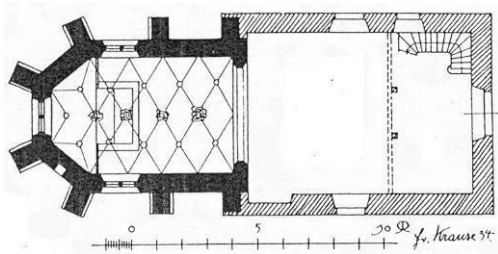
Niederkirchen, ev. Pfarrkirche, Grundriss
